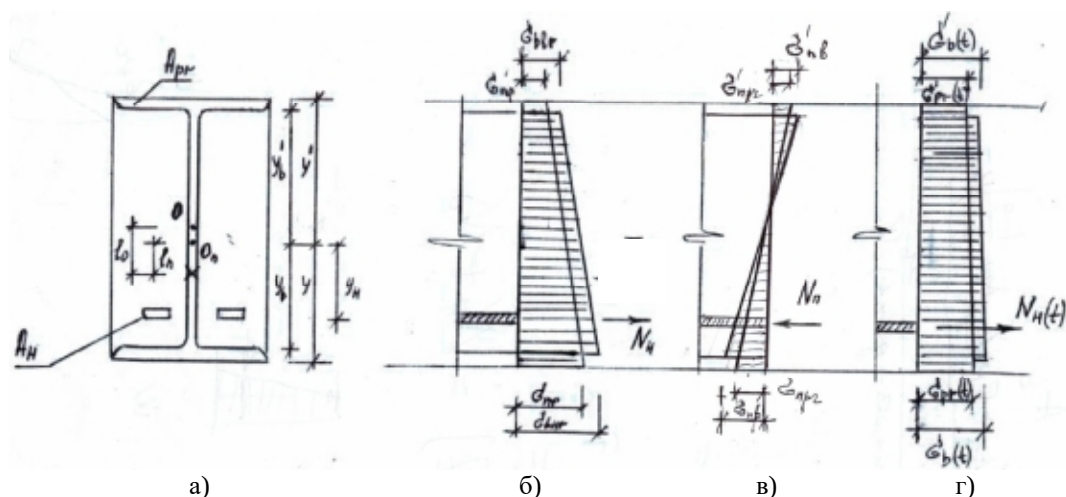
Напряженное состояние в сталежелезобетонном сечении от предварительного напряжения:
